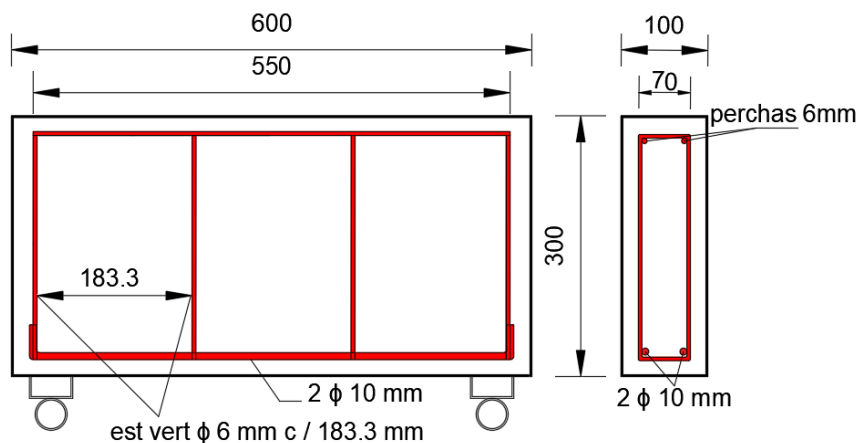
Dimensiones geométricas y detalle de armado de especímenes con armadura a corte mínima.
